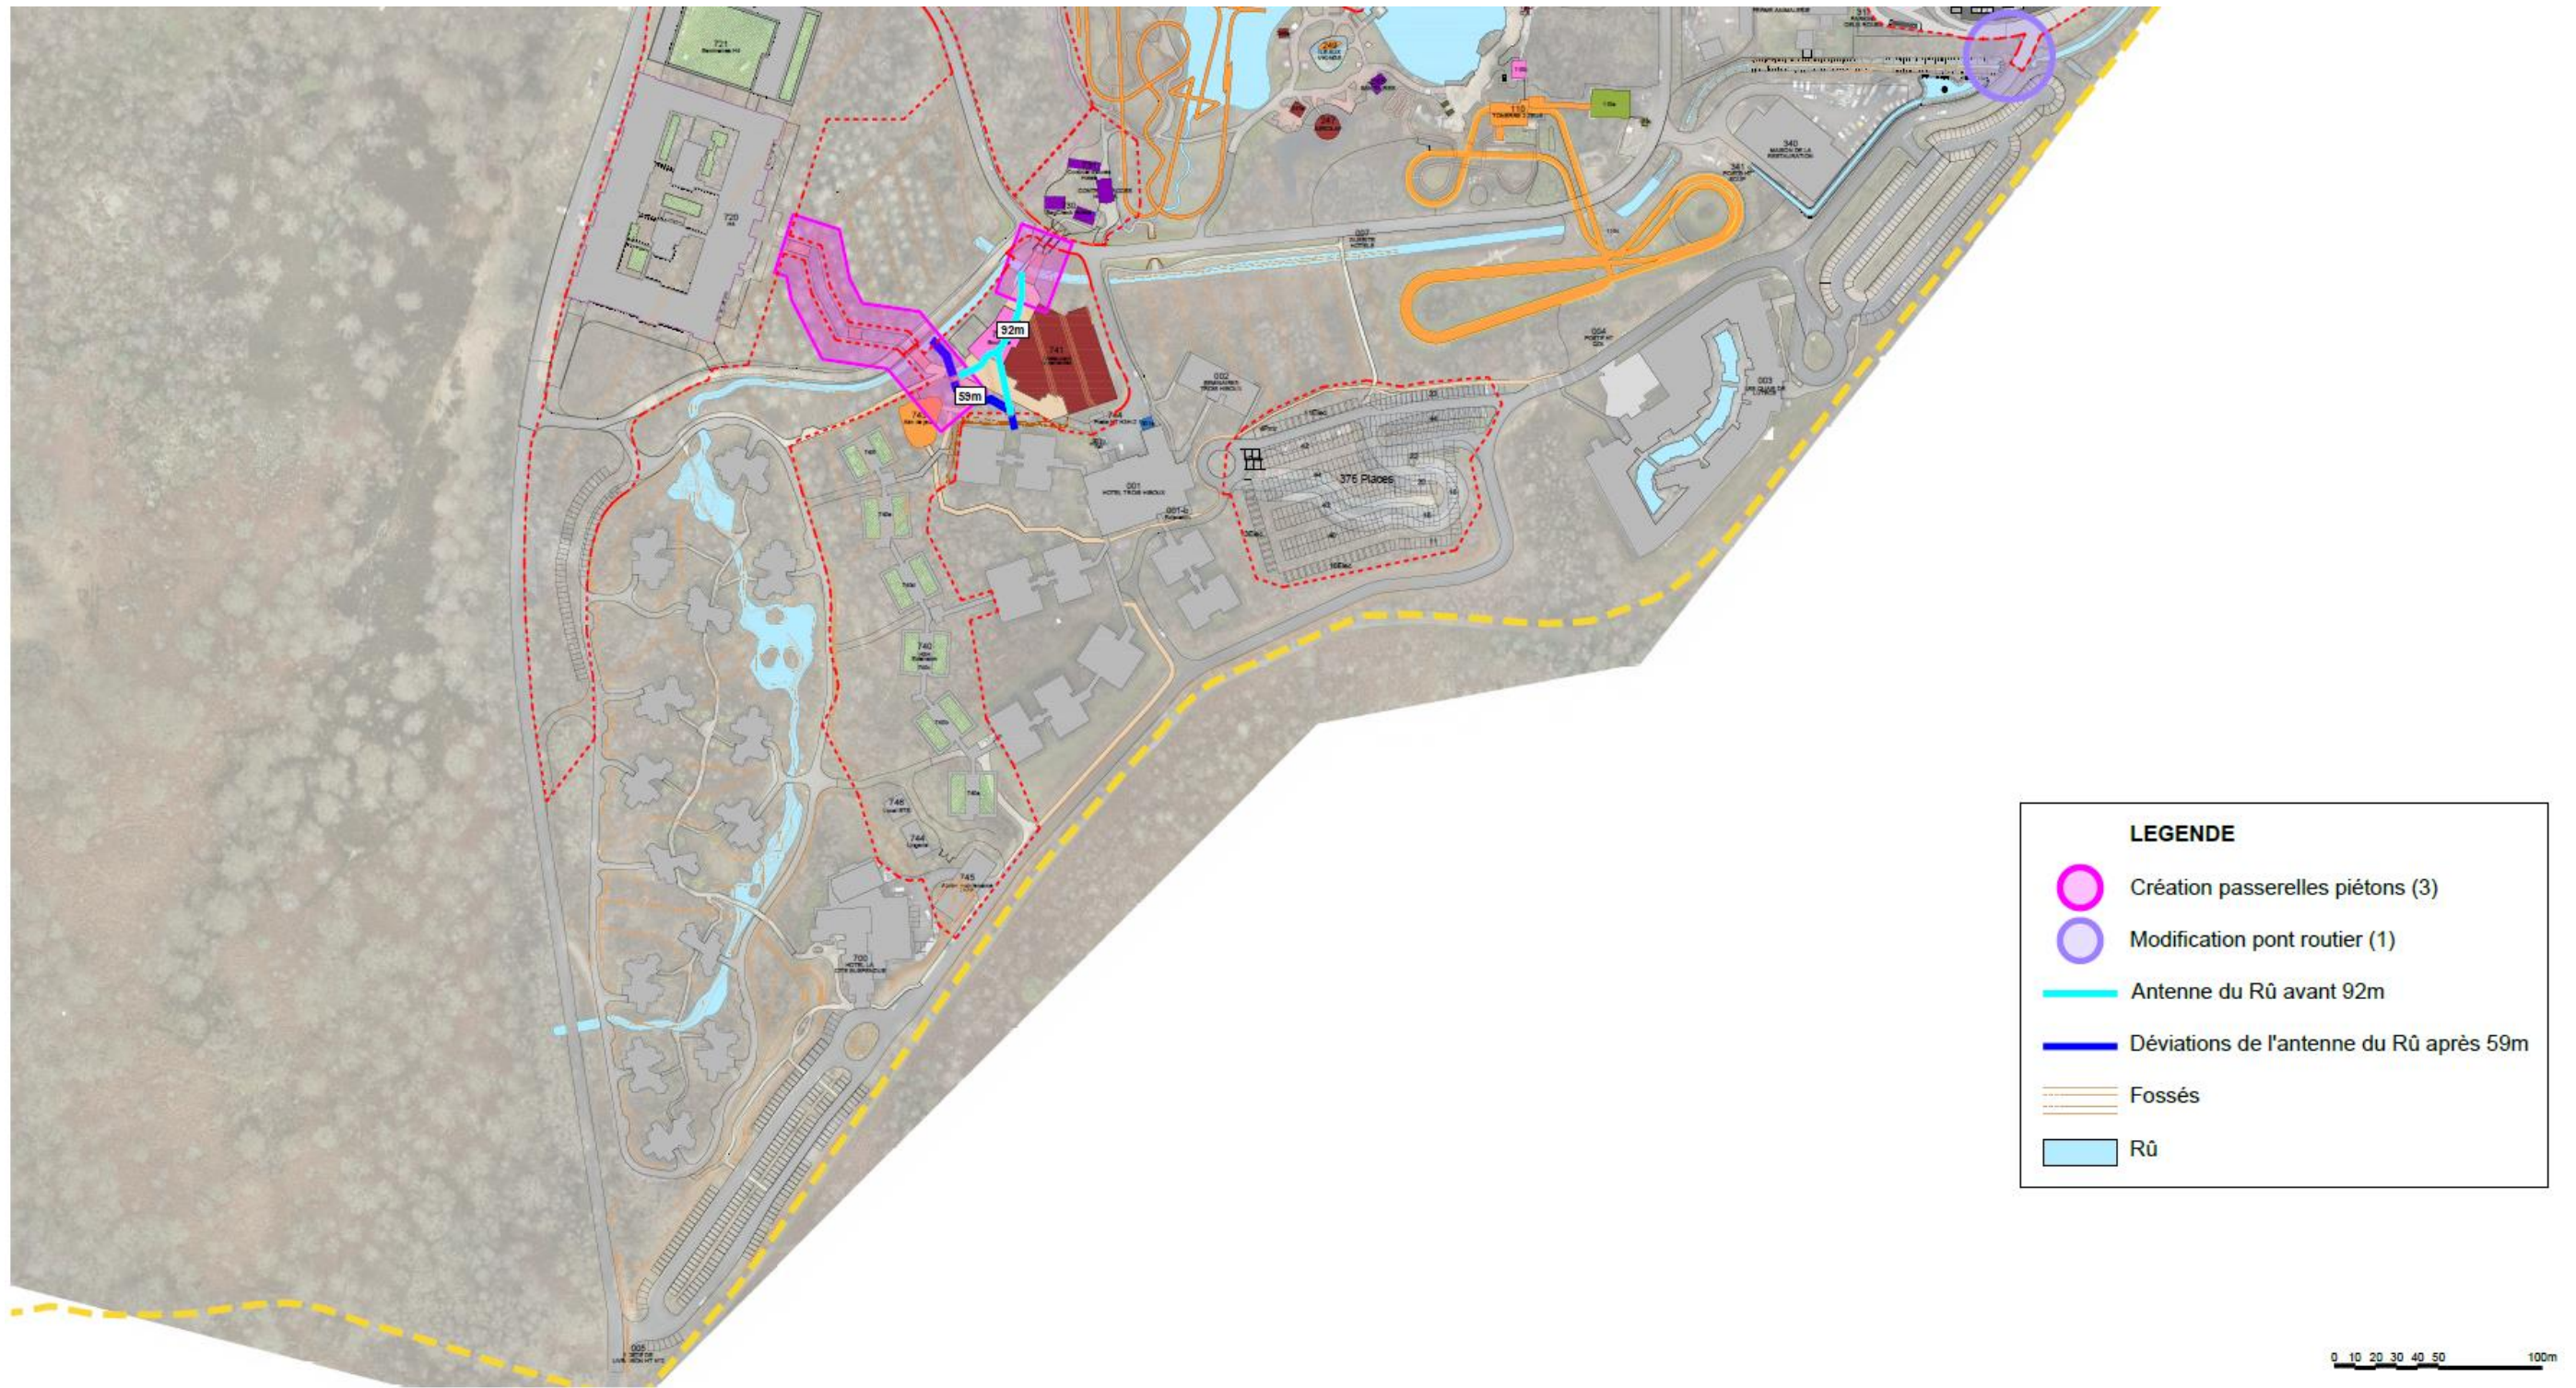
Plan de localisation des ouvrages – Plan 3/3 (Parc Astérix)
